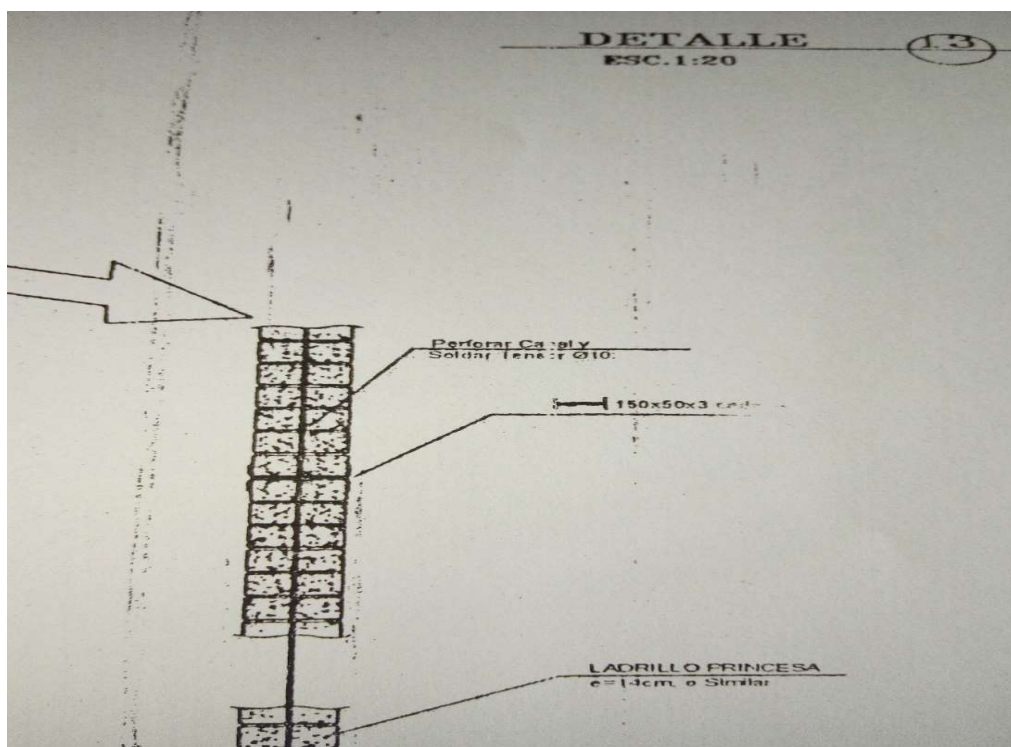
Detalle de refuerzo vertical soldado al perfil.
